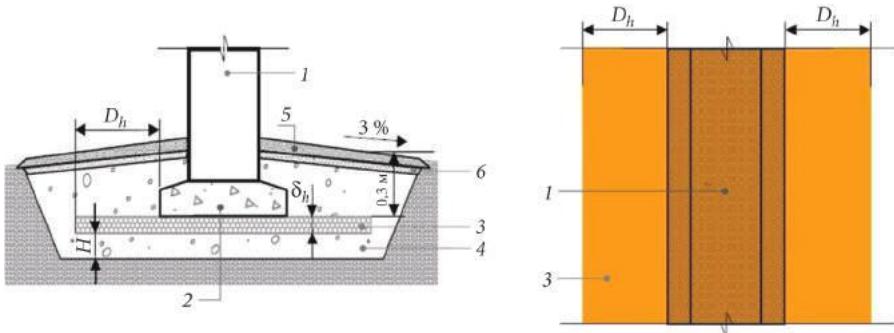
Схема укладки теплоизоляции при устройстве ленточной опоры:
